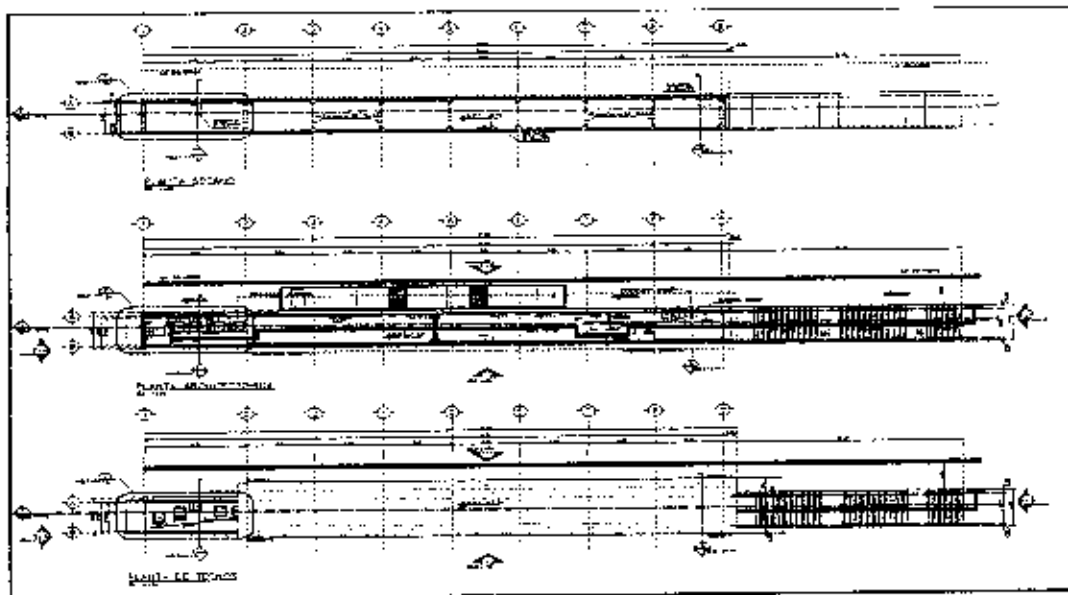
Planta arquitectónica de la estación tipo 2.
